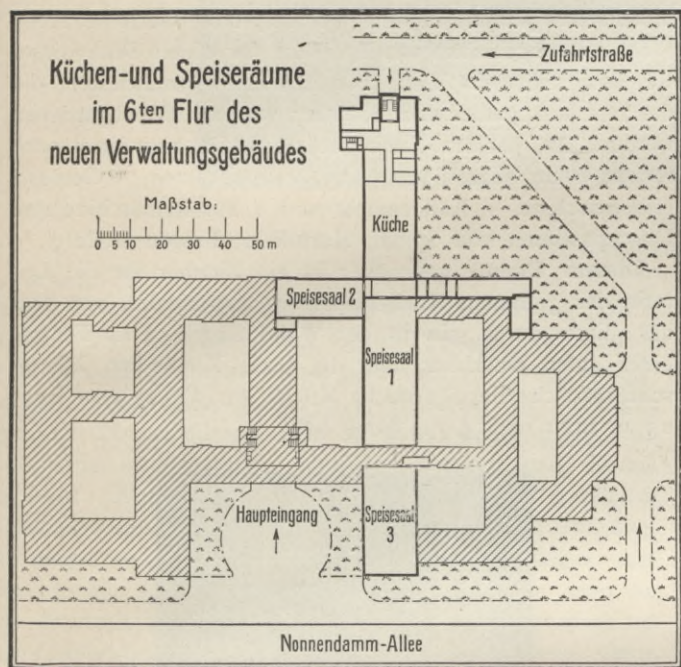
Plan öfver förvaltningsbyggnaden. (Grundriss des Verwaltungsgebäudes.)
